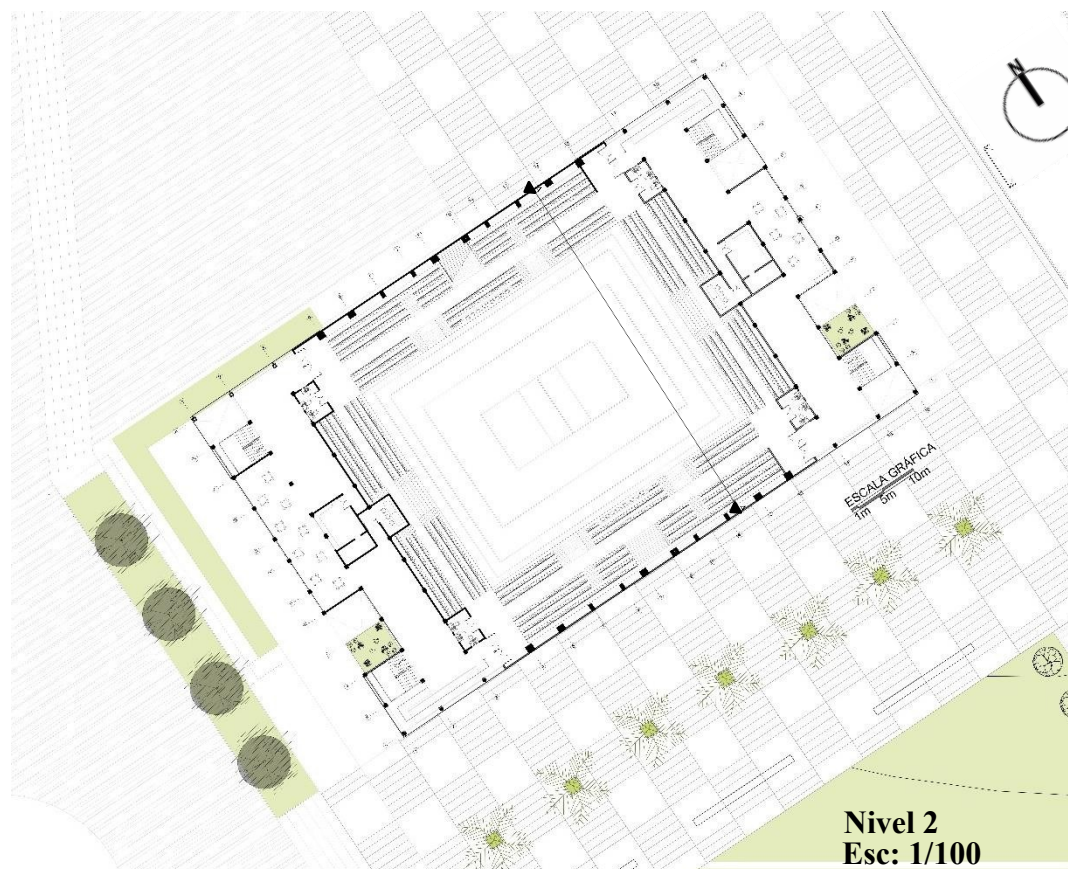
Planta 2 Escenario Múltiple Voley-Basquet
